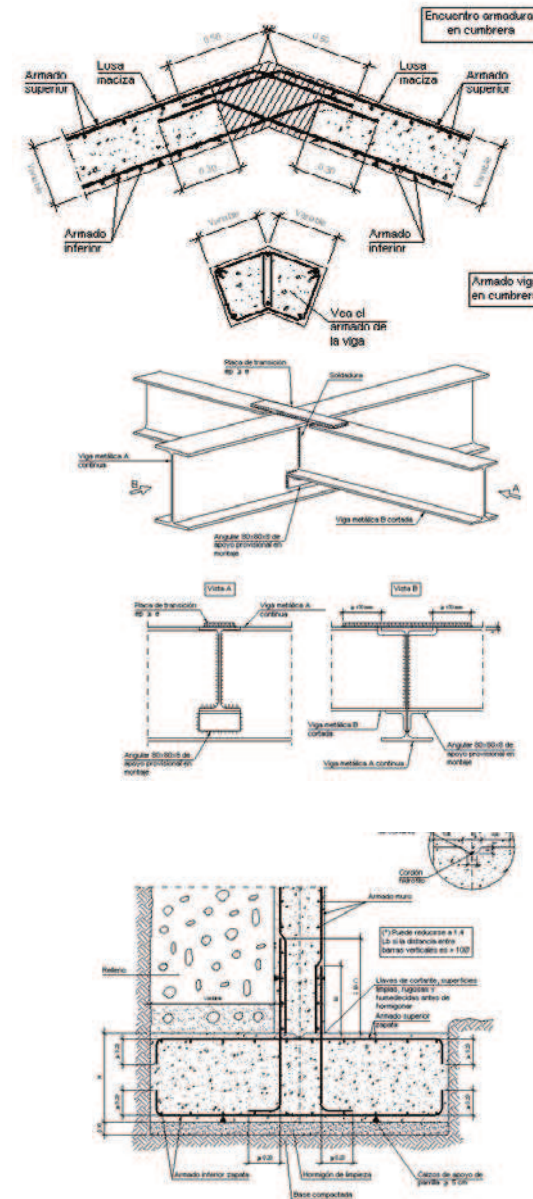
Detalles constructivos. Fuente: Collage ilustrativo.
